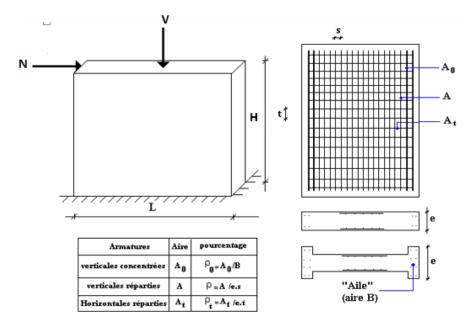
Schéma d'un voile plein et disposition du ferraillage.
